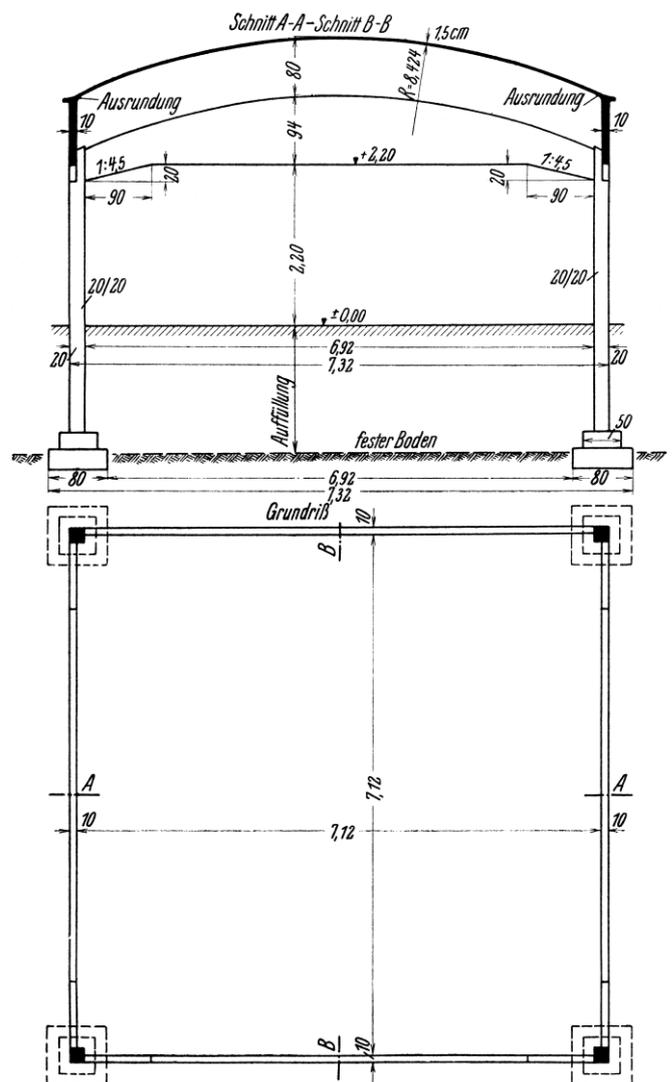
Grundriss und Schnitt der Dywidag-Versuchsschale von 1931 [17]
